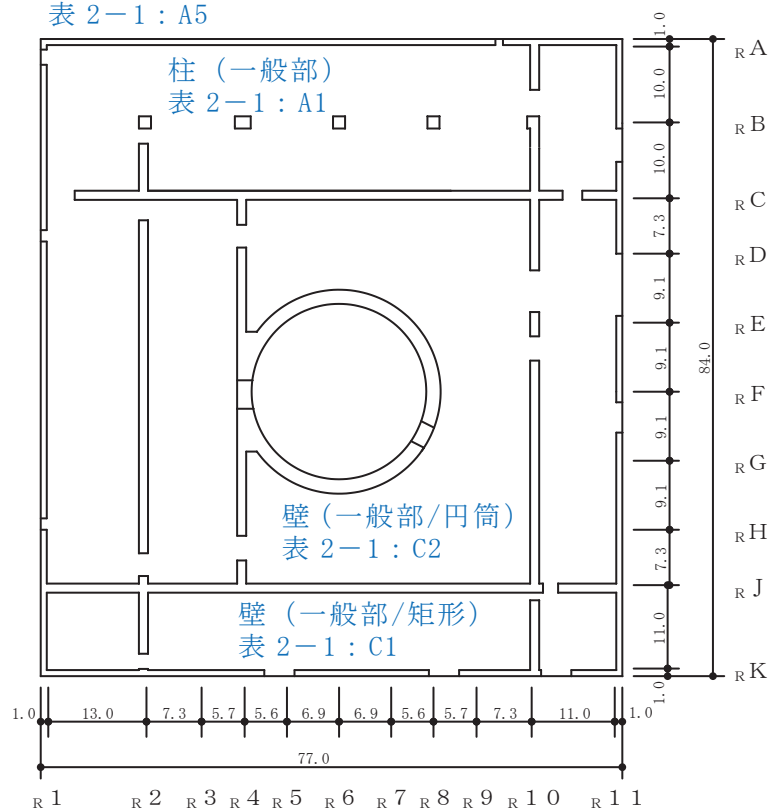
(3) 原子炉建屋の概略平面図 (0.P. 6.0m)
